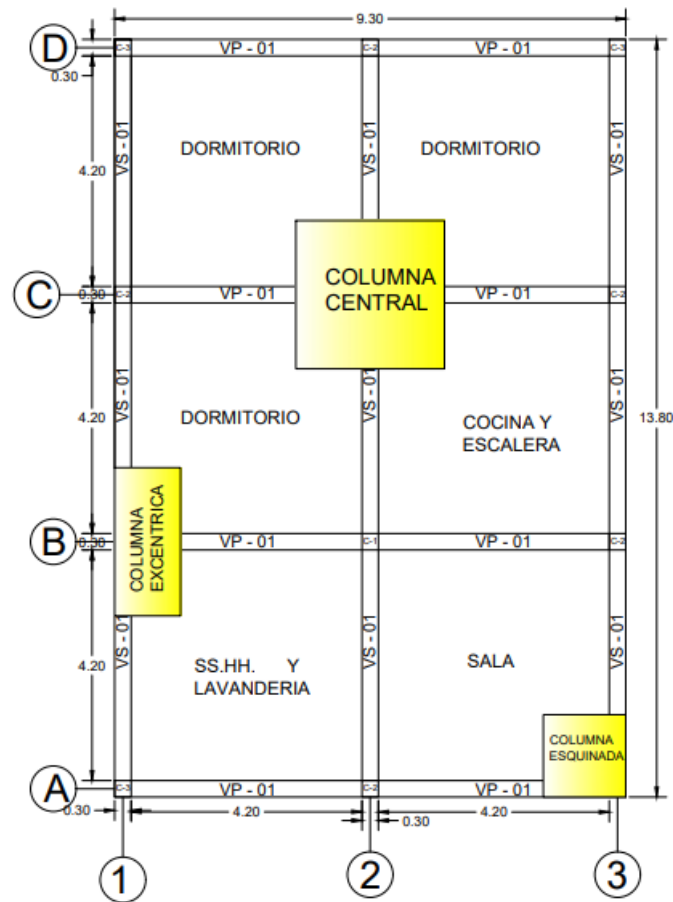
Detalles del plano en planta de la edificación prototipo.
